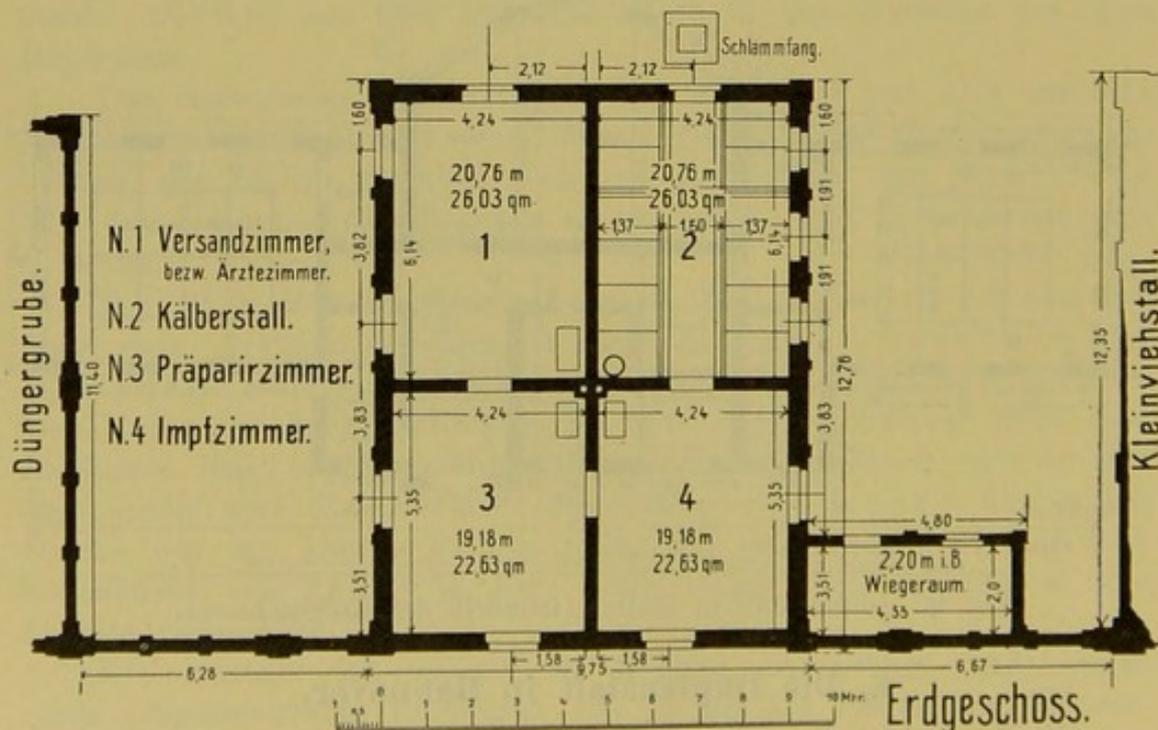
Impfanstalt in Hannover: Grundriß des Erdgeschosses.
